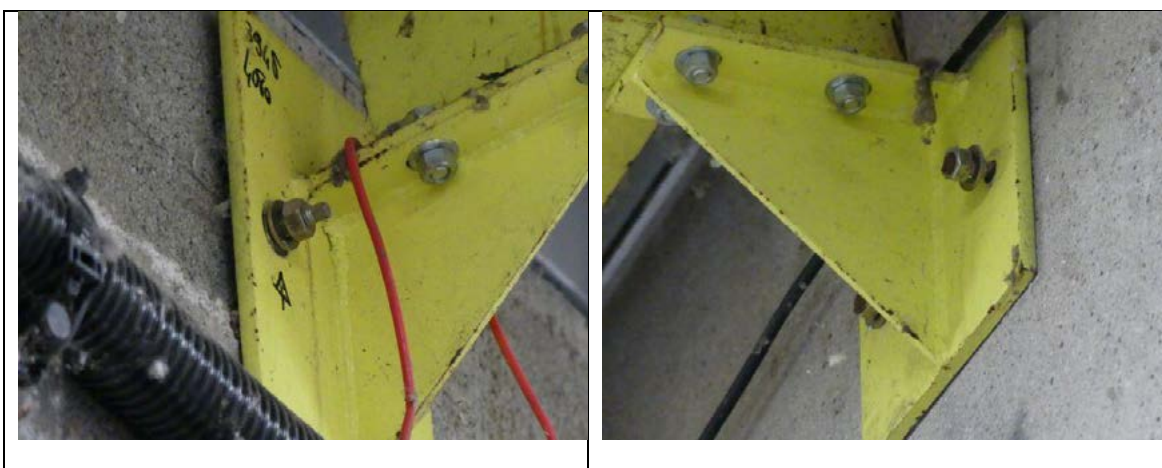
Desserrement des écrous et glissement du goujon du support mur.
